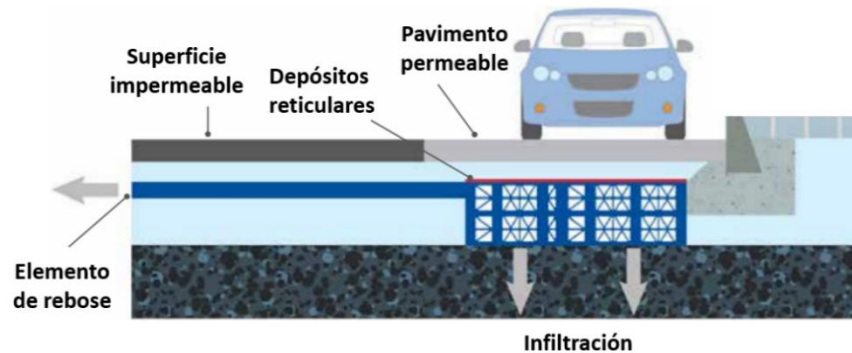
Esquema de un depósito reticular. Fuente: Adaptado de Polypipe (2016).
